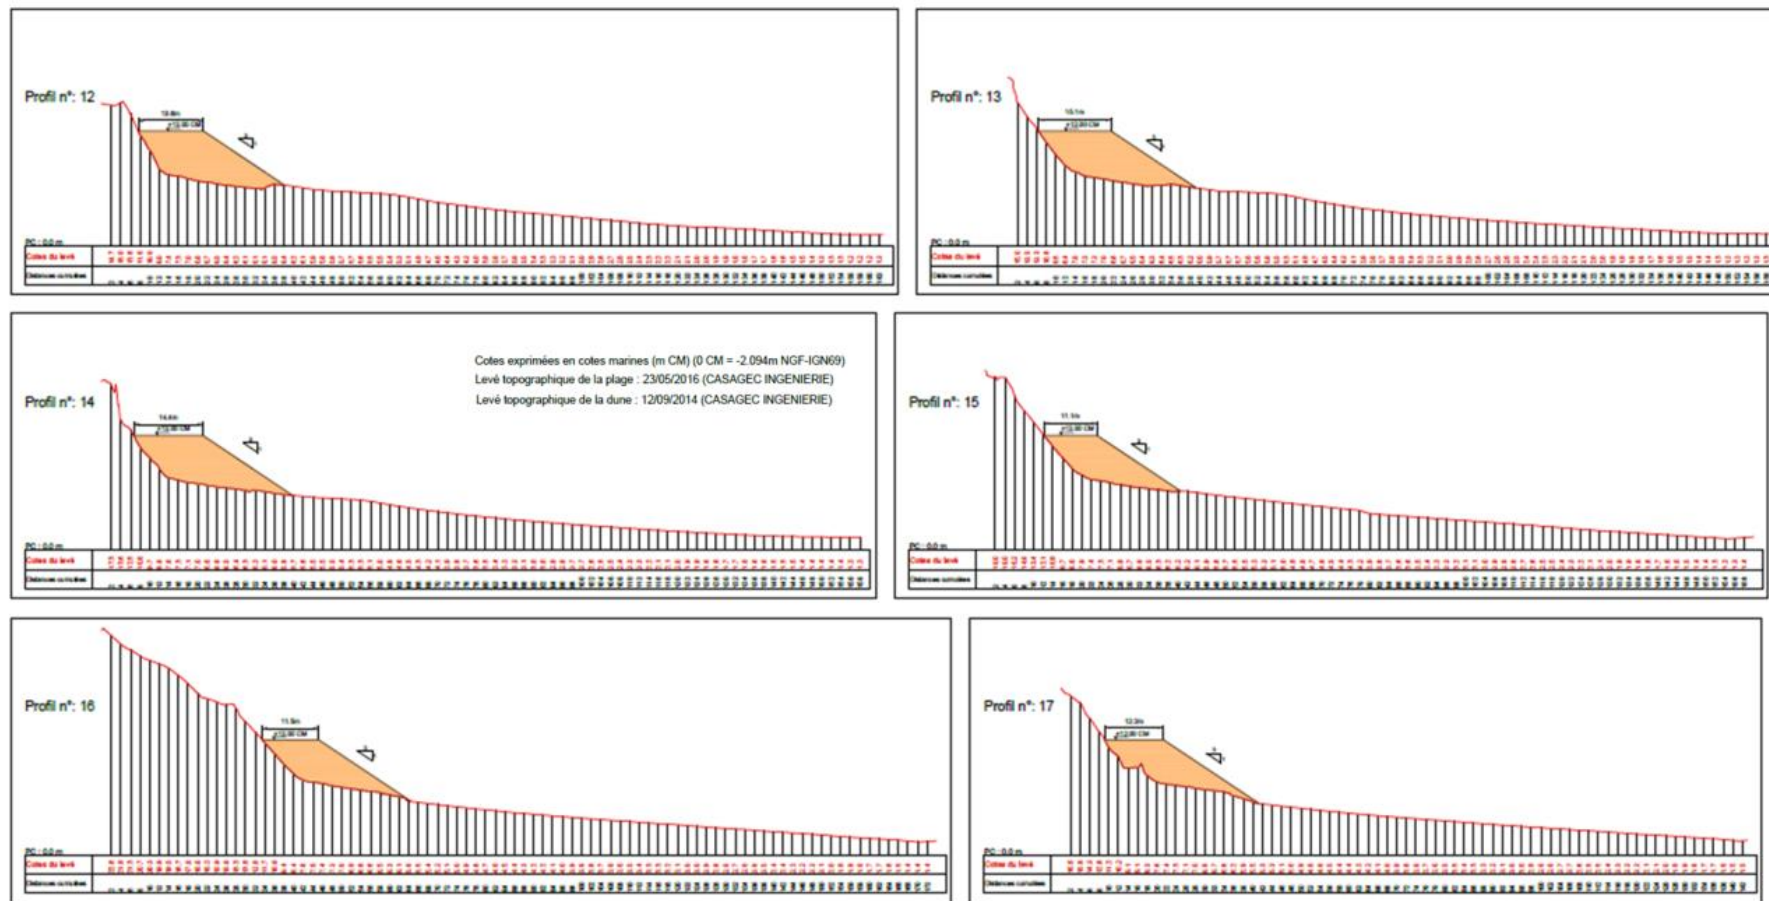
Profils type des rechargements des plages Sud (page de la Savane à la plage de la Piste) 2/2.
